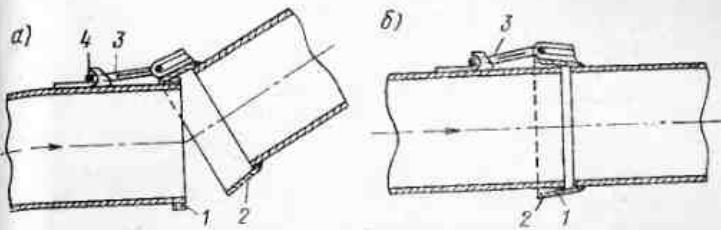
Быстро разъемное соединение для намывных пульпопроводов
